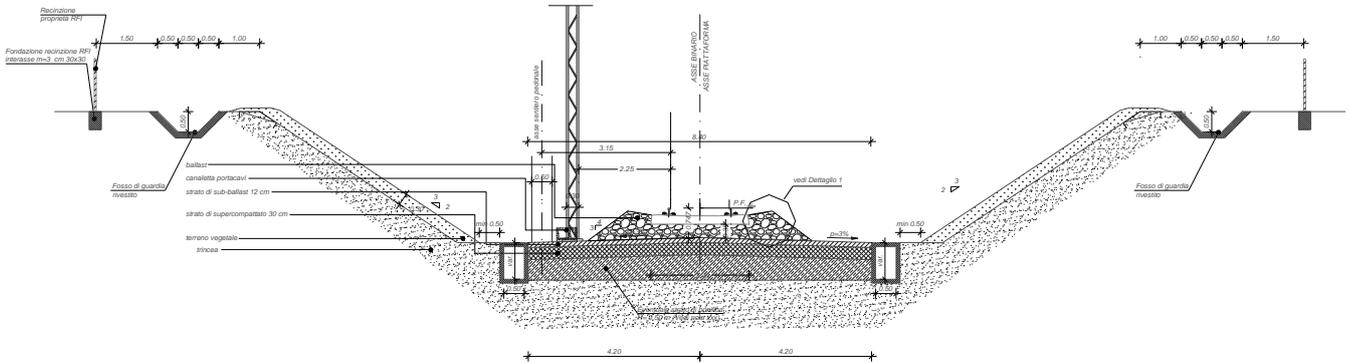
Sezione tipo ferroviaria in trincea a singolo binario in rettilo
